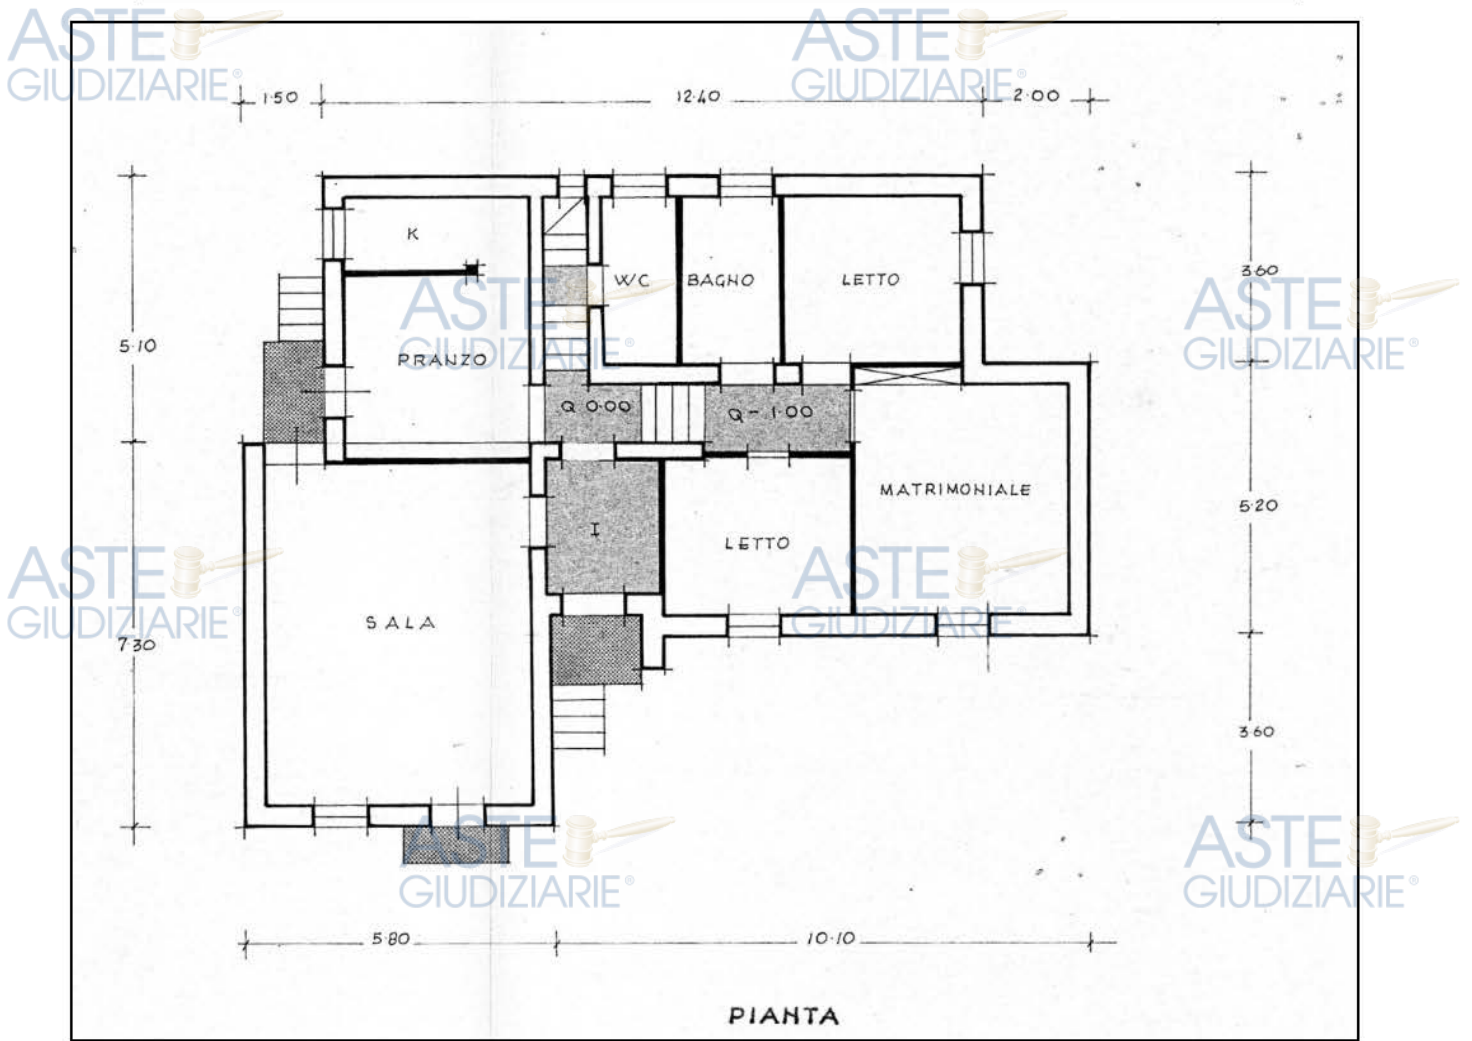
Subalterno 1 – Piano Terra – Planimetria stato di progetto – Concessione Edilizia n. 981
